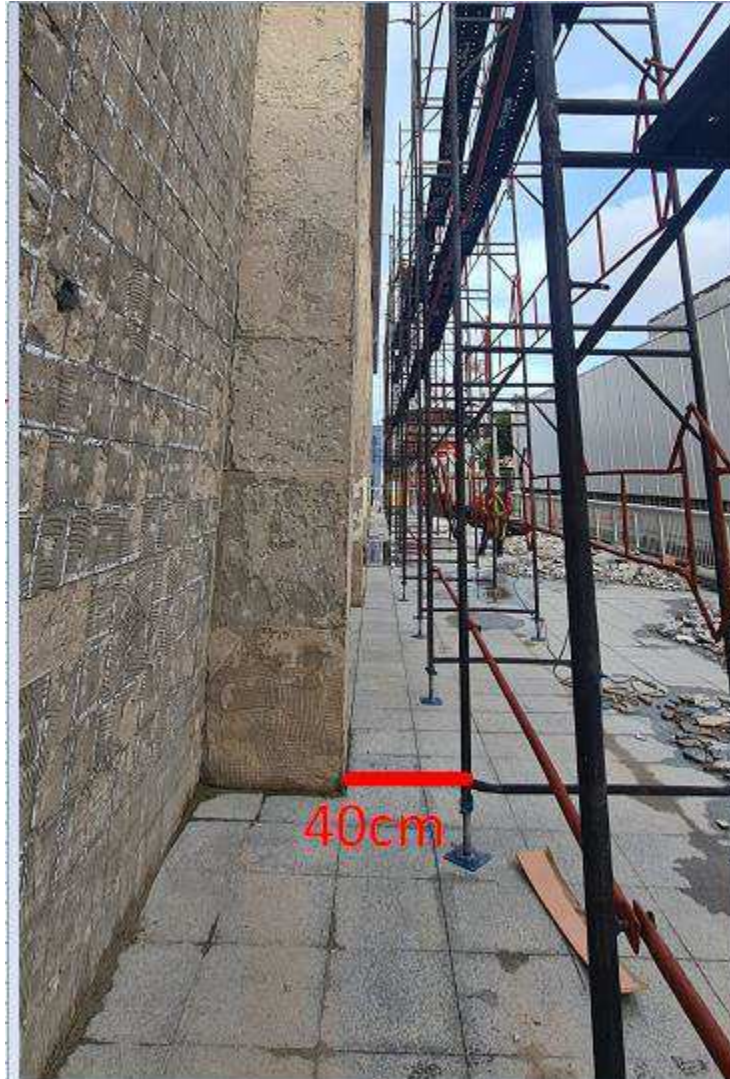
Detalhe do recuo dos andaimes modulares fachadeiros da fachada Sul da edificação na dimensão de 40cm para possibilitar a montagem e fixação das peças.
